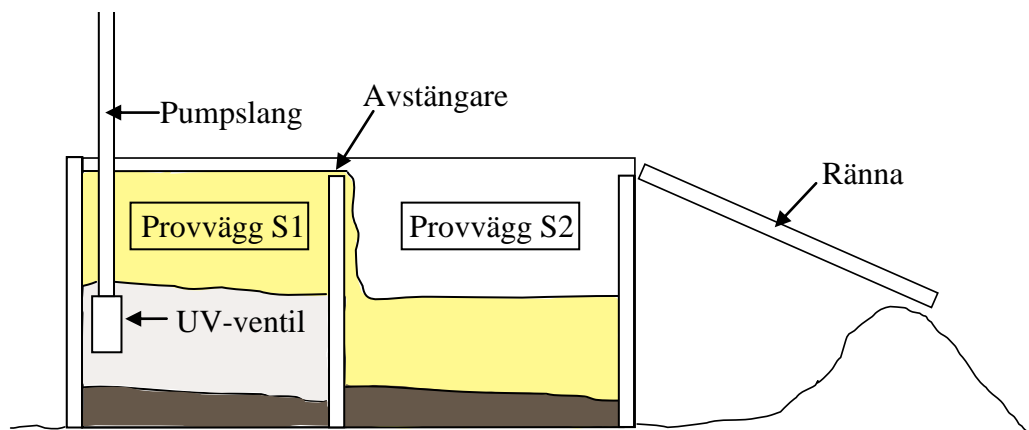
Gjutning av provväggar med betongpump och betongbil.
